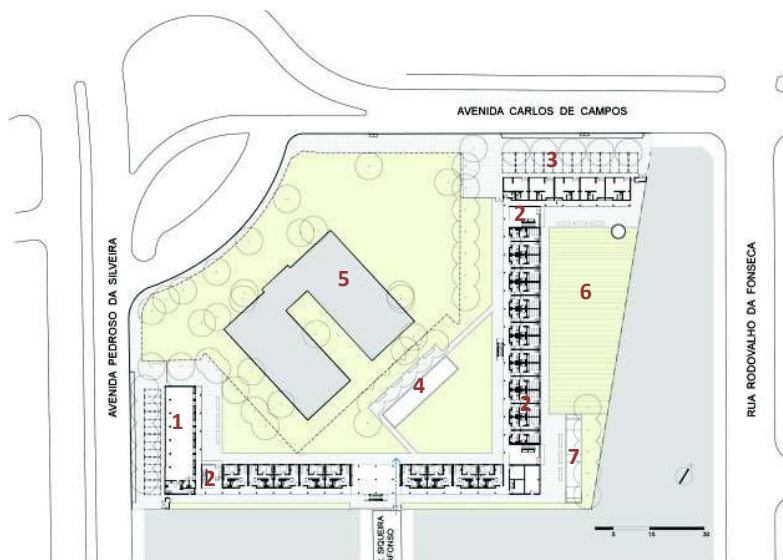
Planta de Implantação do Conjunto Residencial Vila dos Idosos.
